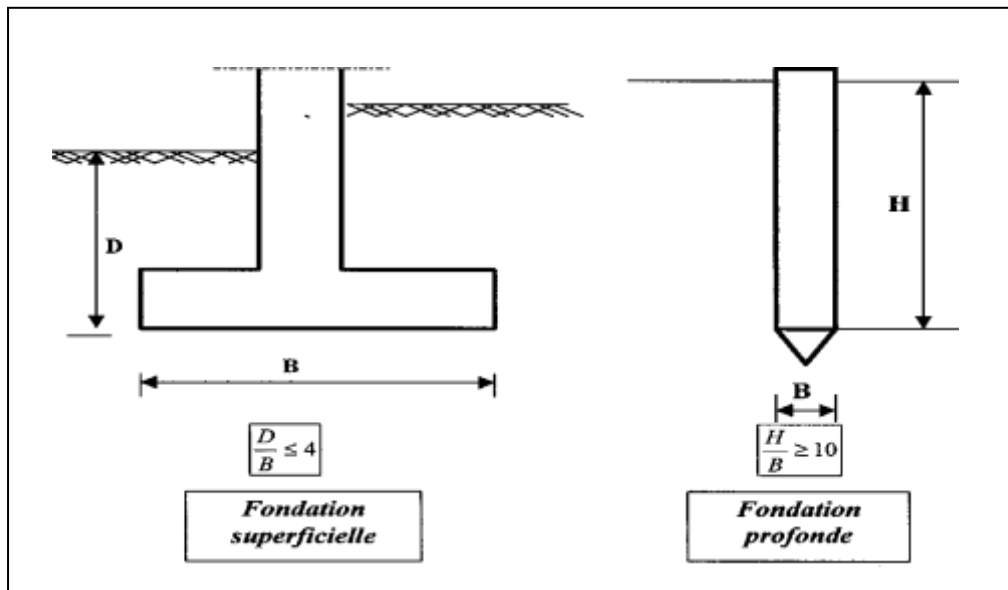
Coupe verticale des fondations profondes et superficielles
